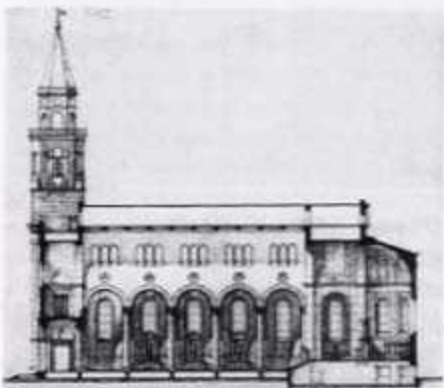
C. Bazzani. Pescara. Cattedrale di S. Cetceo. Sezione longitudinale di progetto (ibidem).
